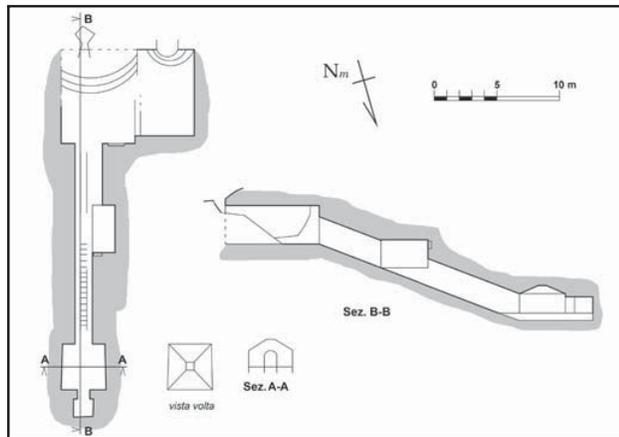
Planimetria e sezione dell'ipogeo n. 10, "casa del Chirurgo" (Copyright CRSE).
